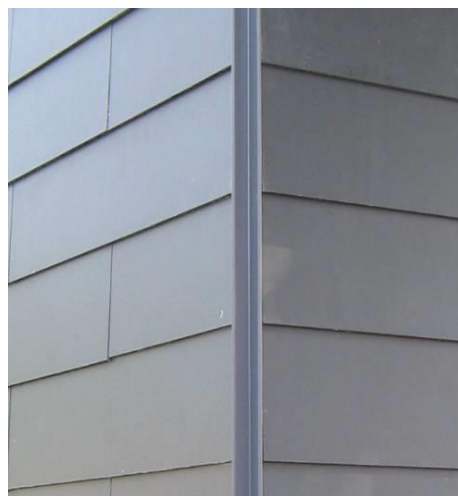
Voorbeeld van een afwerking van buitenhoek (voorbeeld met halfsteensverband)
